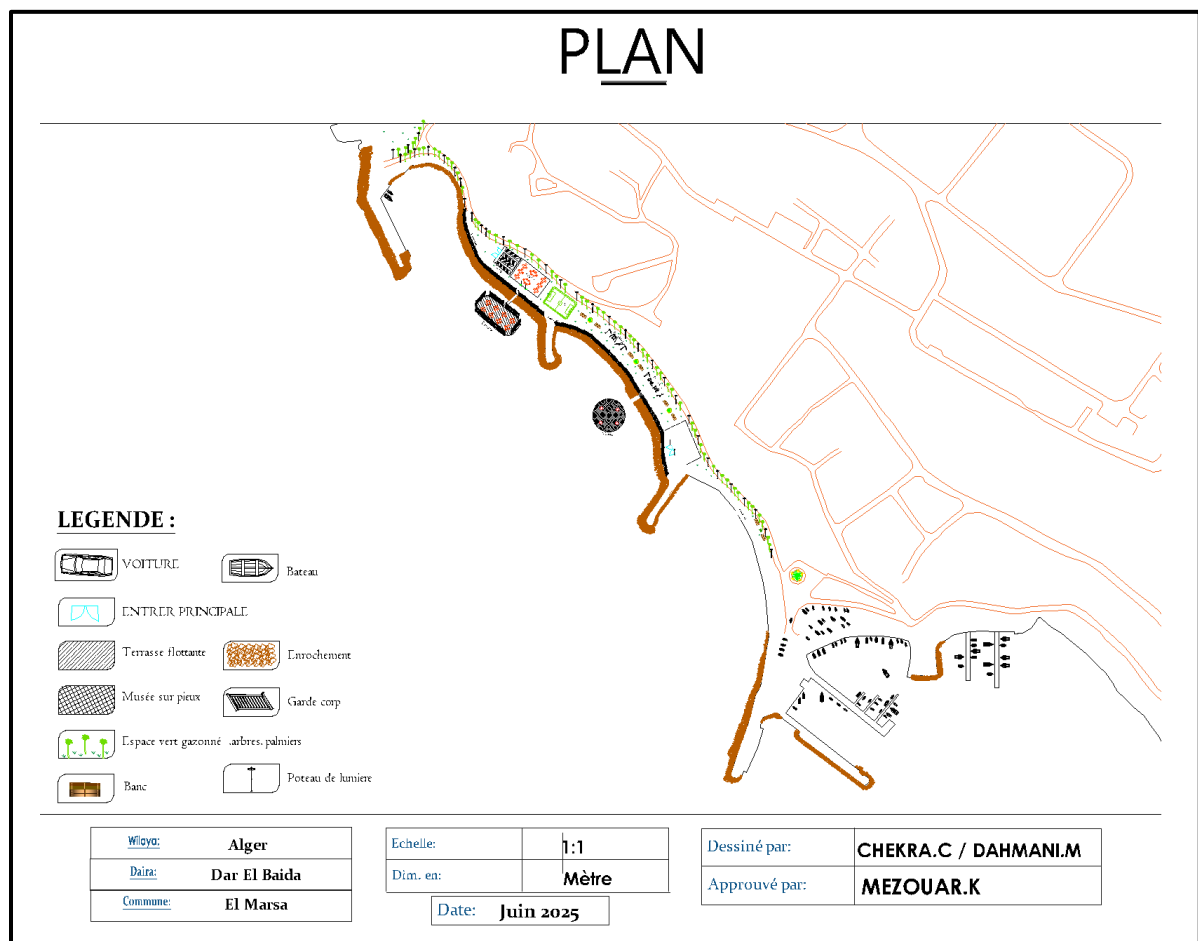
Plan globale de l'aménagement sur AutoCAD
